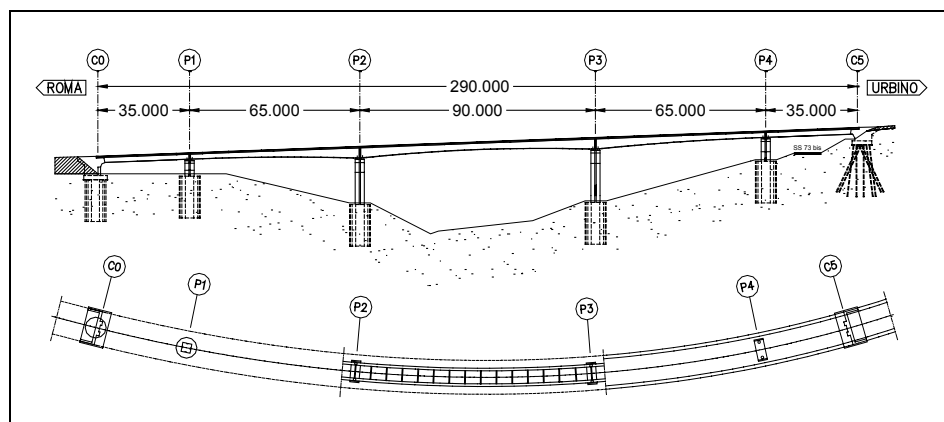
Viadotto Santa Maria: prospetto e pianta
